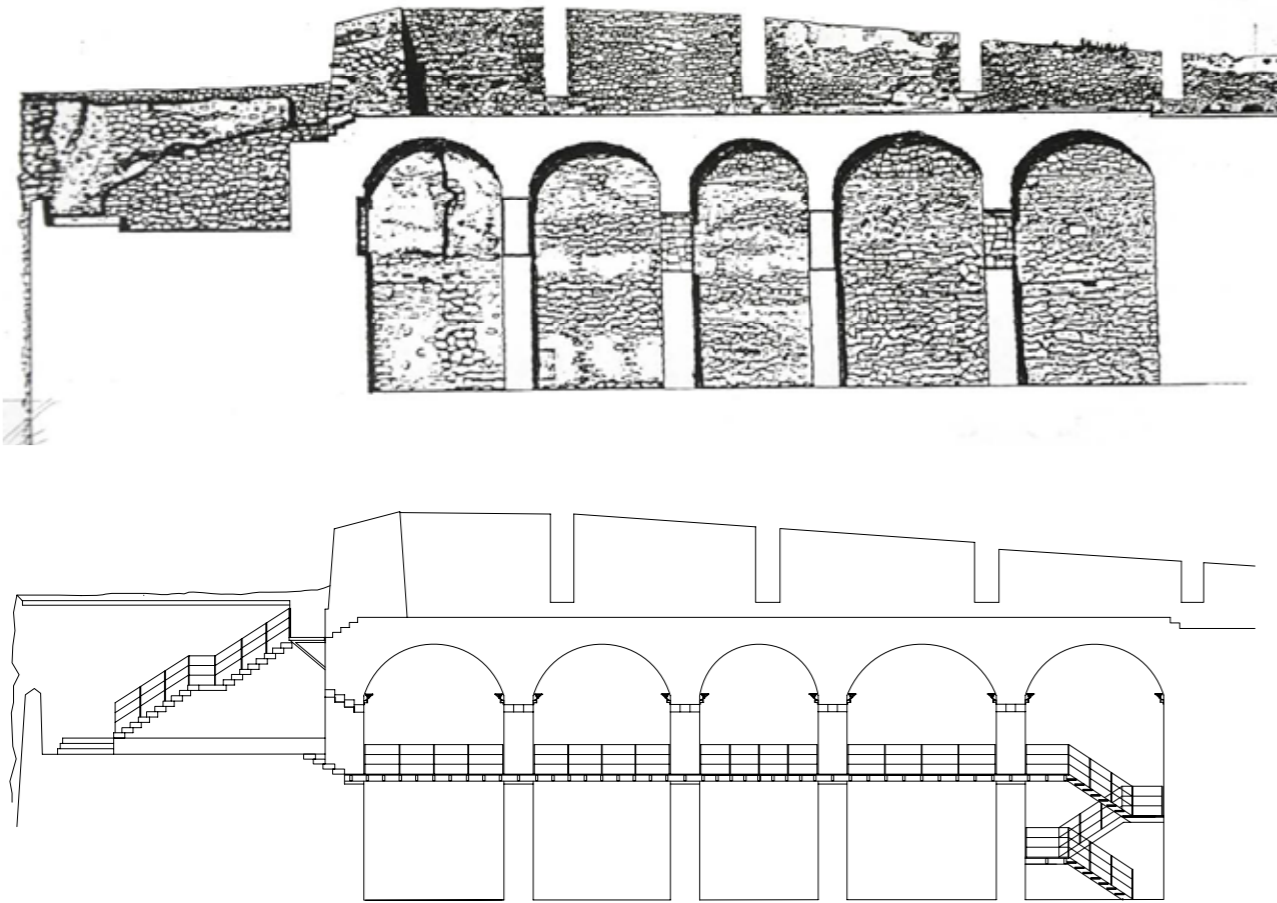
Secciones por las bóvedas del baluarte de Santa María. Planos del Proyecto de restauración urbana Plaza de Les Caseres y baterías de Santa María, Santa Ana y de la Fuente. Arriba estado anterior y abajo propuesta de proyecto para la pasarela y escaleras. (MJB 1998).
